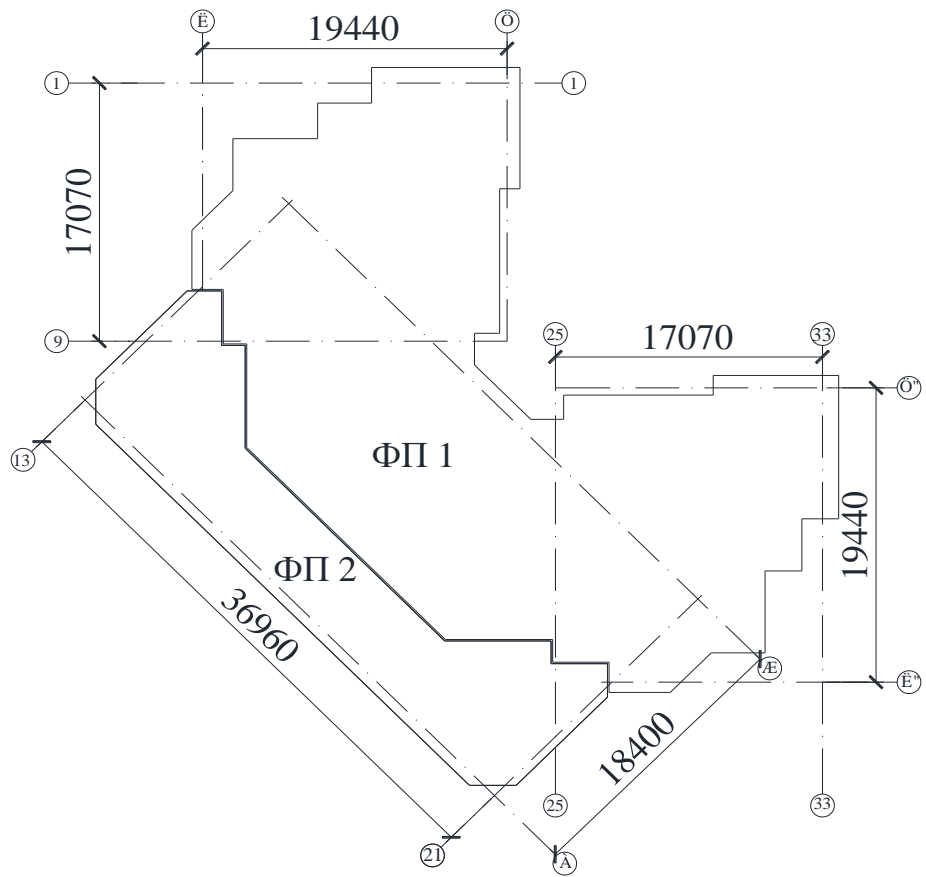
Блок-схема по розміщенню фундаментних плит
